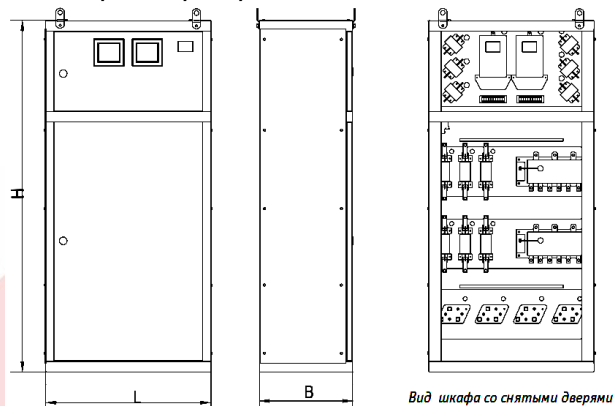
Установочные и присоединительные размеры ВРУ-3
